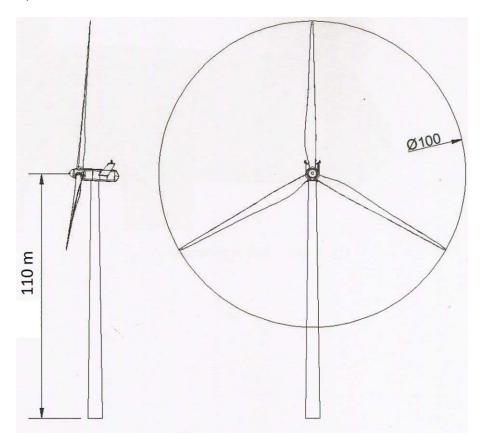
Dimensões da turbina Vestas V100 2.0 MW
